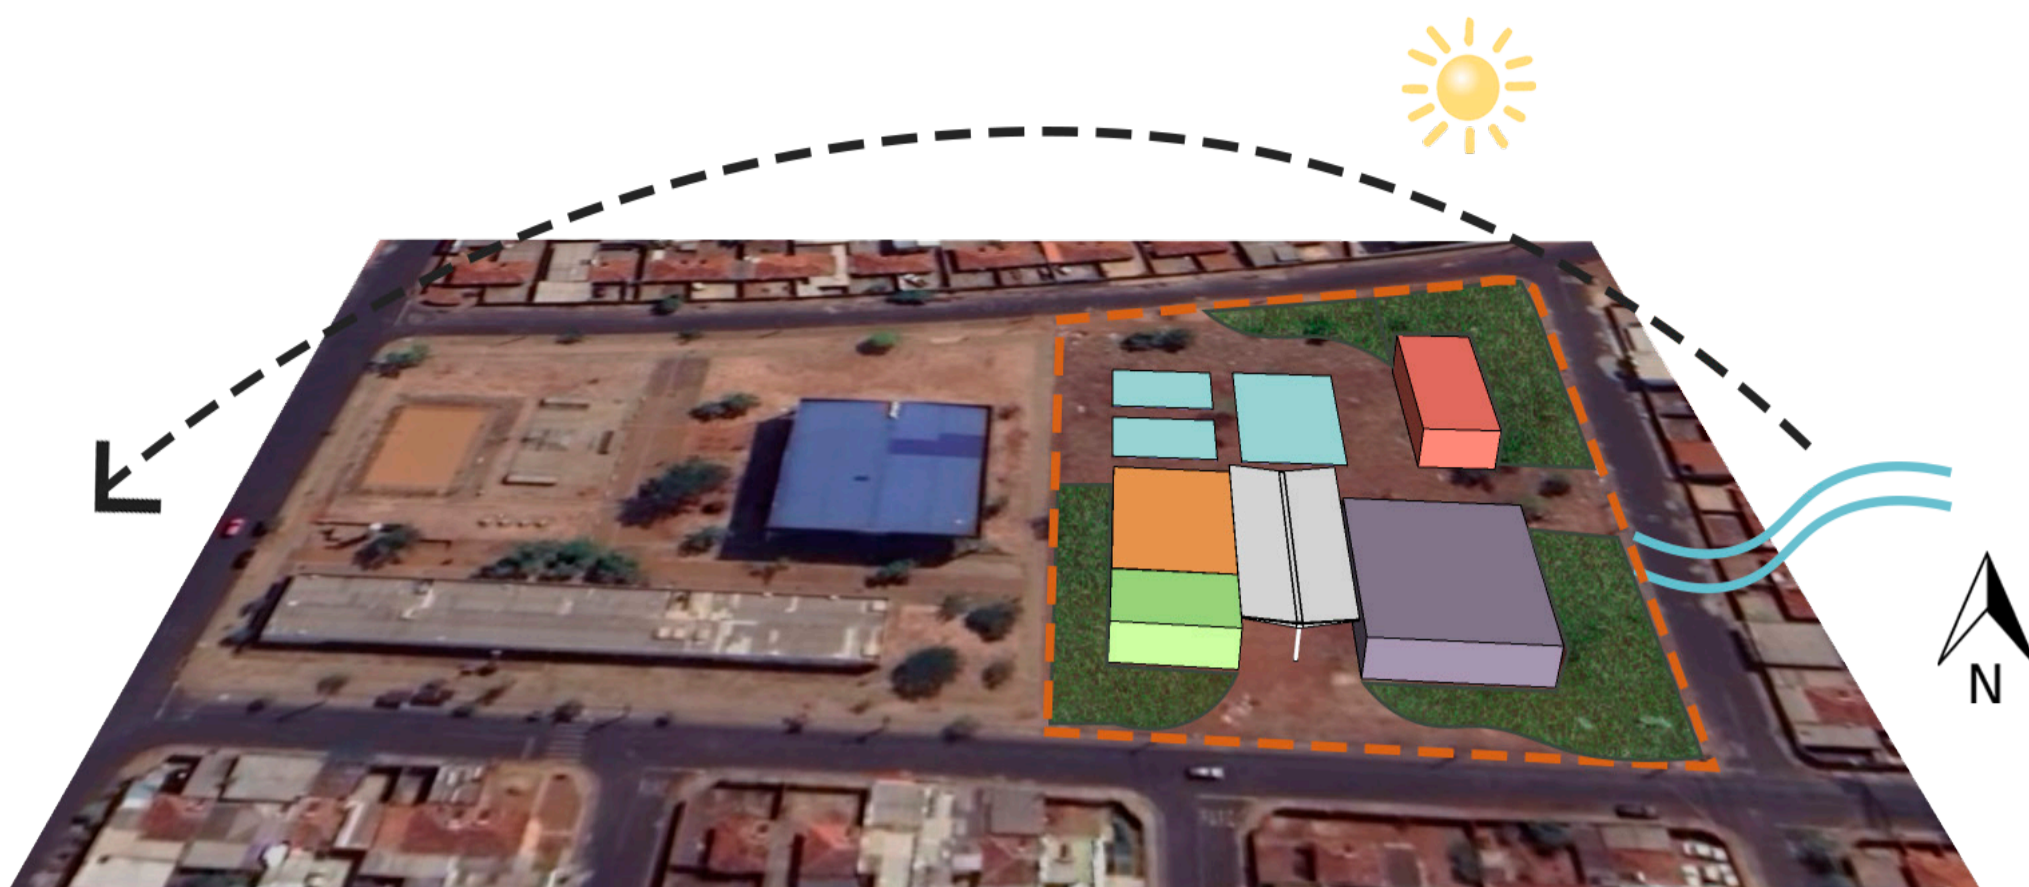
Proposta preliminar de implantação do Centro no bairro Shopping Park. Fonte: Autora.
